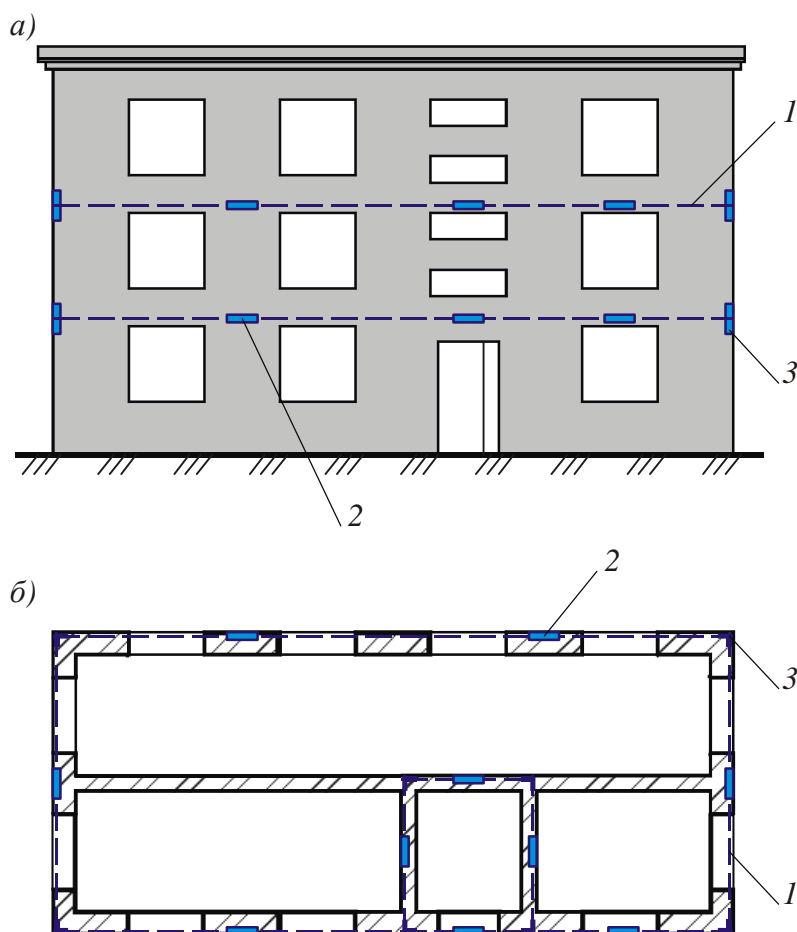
Усиление стен стальными тяжами, устанавливаемыми в стенах:
